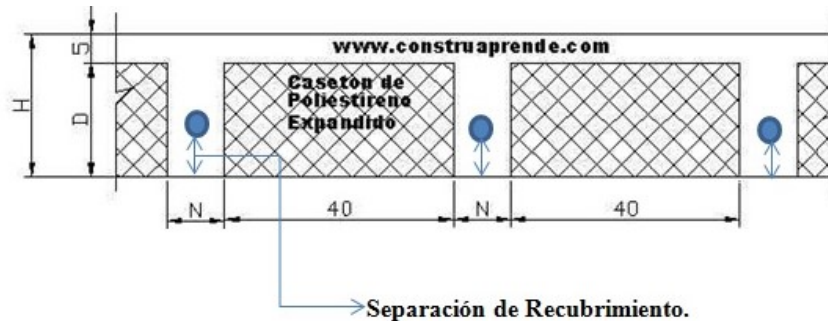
Sección Típica de Losa Nervada- Recubrimiento. (<http://www.construaprende.com/>, 2016).
